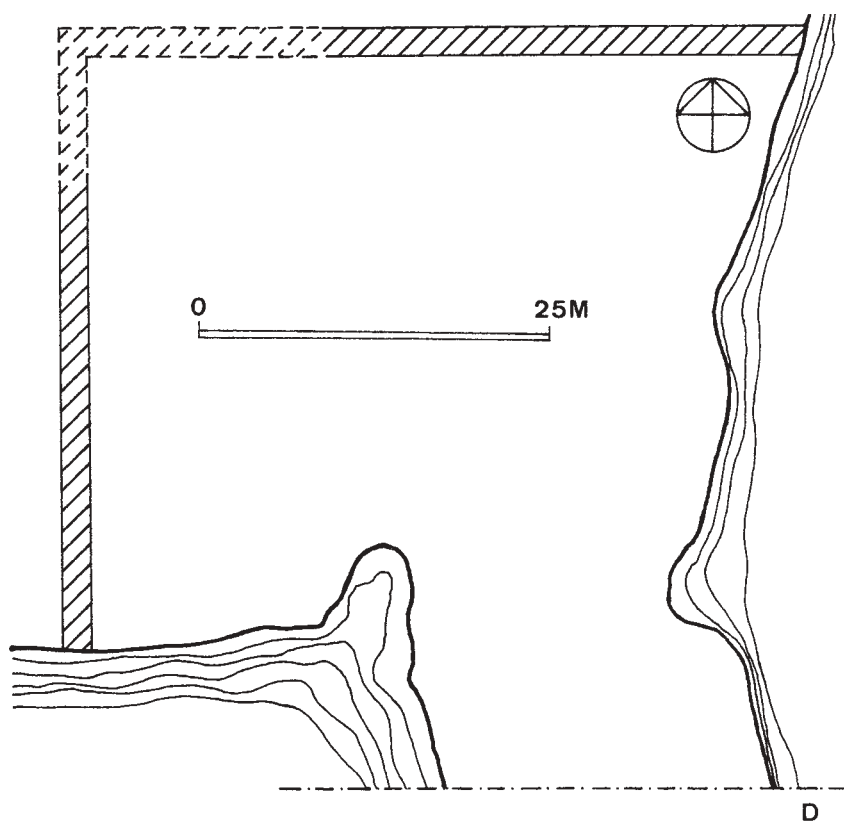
Planta do Castelo de Porches (Lagoa).
